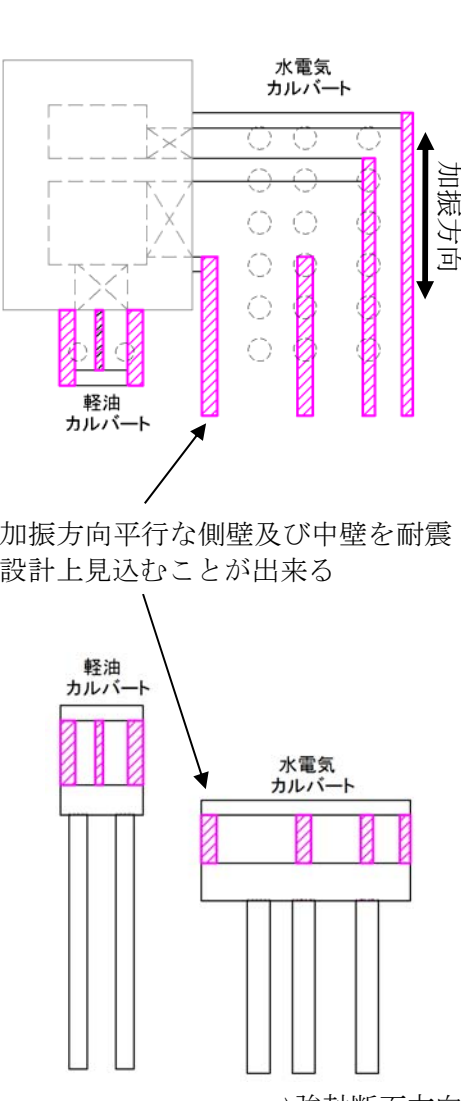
(2) カルバートの平面配置図 (拡大図)
